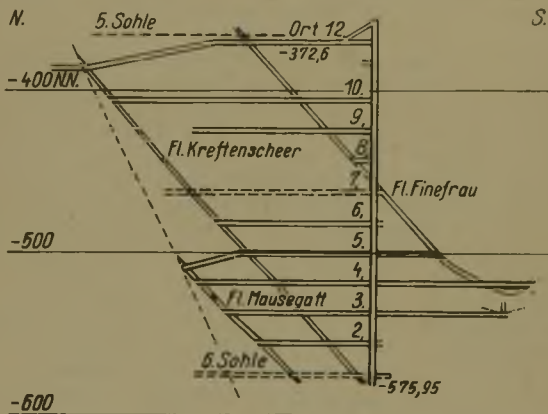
Ausrichtung in steiler Lagerung für Abbauführung mit Kurzstrebbaubau.
